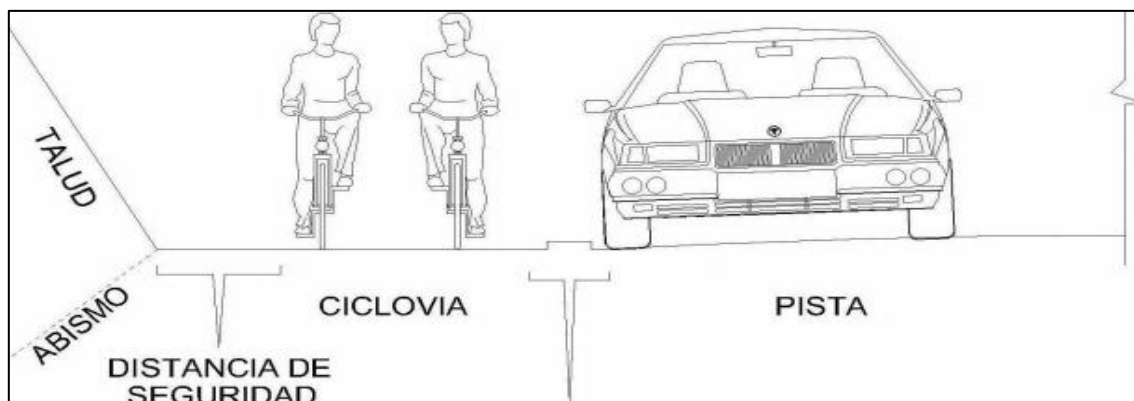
Ejemplo de elemento de segregación - Tachones entre dos franjas pintadas y de un ancho de 10 cm - vista frontal.
